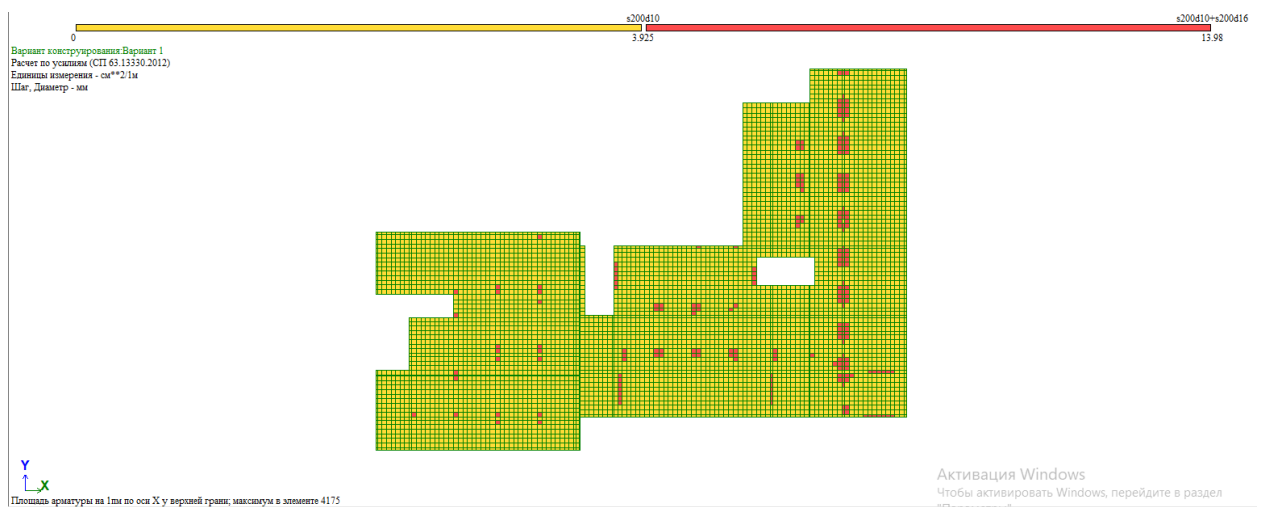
Подбор верхней продольной арматуры плиты по оси X
